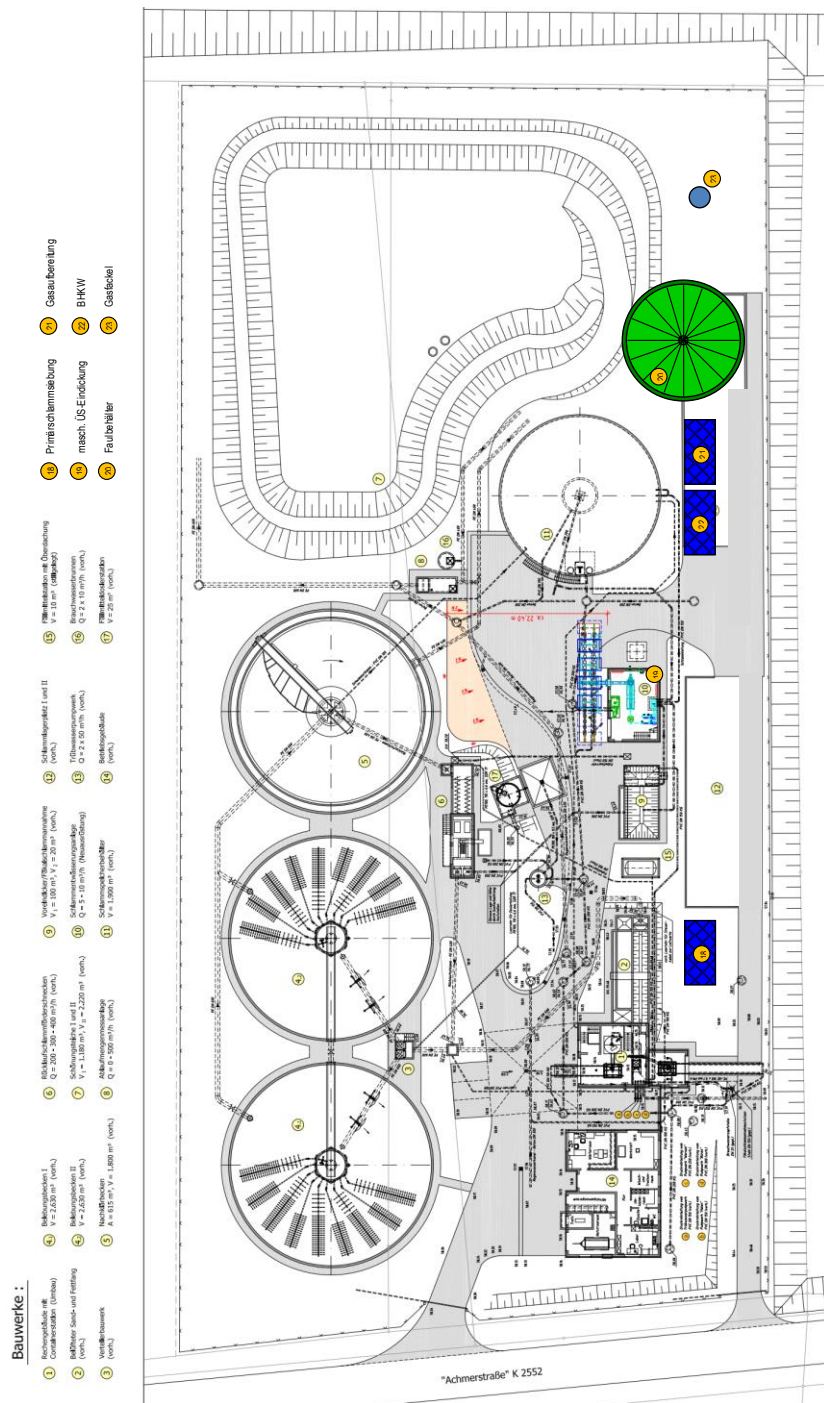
Lageplanskizze der Kläranlage Wersen mit Faulung
